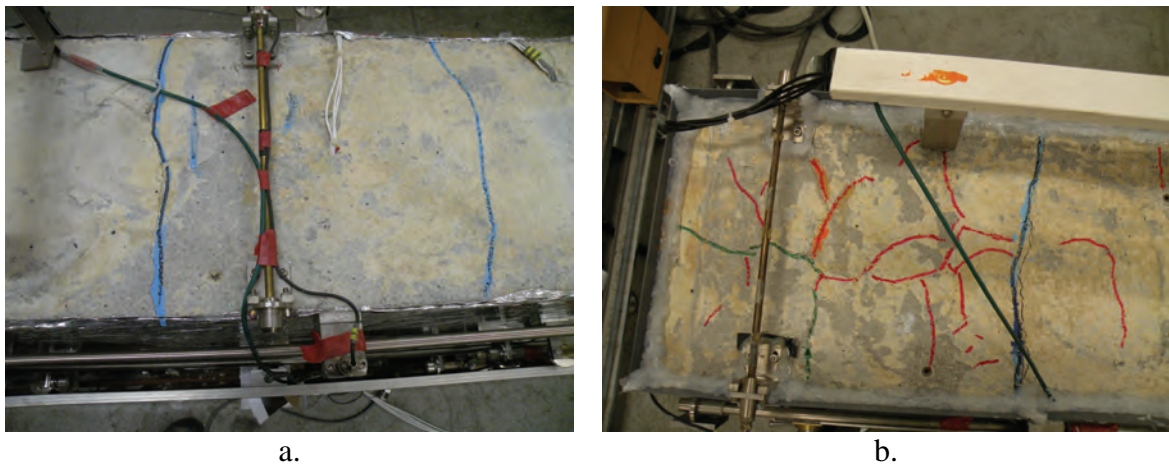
fissuration en face supérieure de P3 (a. 250 jours ; b. fissuration en faïençage à 427 j)
